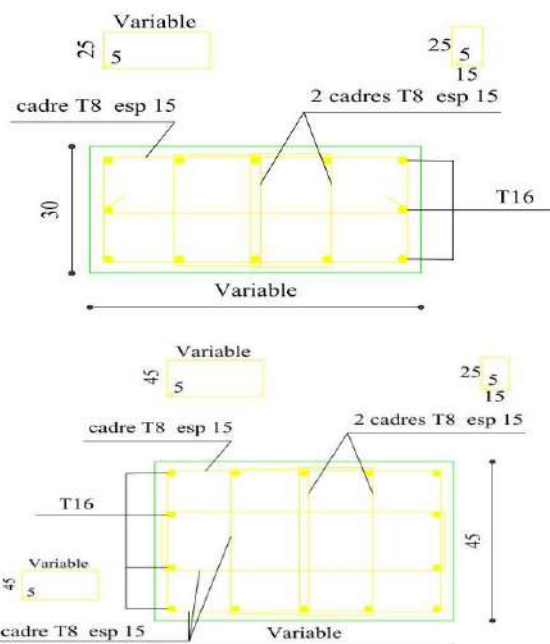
1: Deux sections variables de l'armature de la porte, source : dossier graphique béton et béton armé réalisée par l'ingénieur du BET
